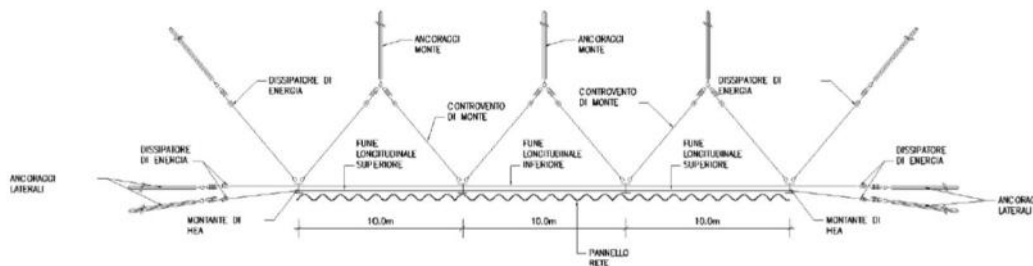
Imbocco Nord Scaleres – Barriere paramassi - sezione
